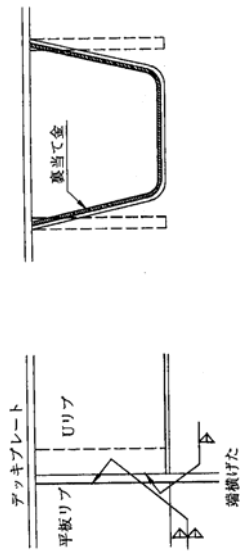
閉断面リブと端横リブ又は端横桁の交差部構造の標準
